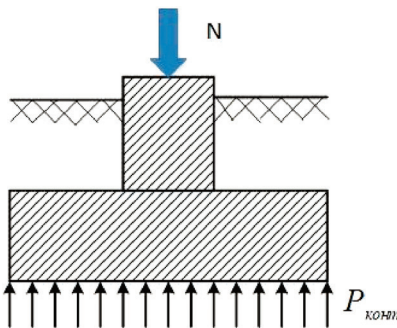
Схема работы фундамента здания под нагрузкой
